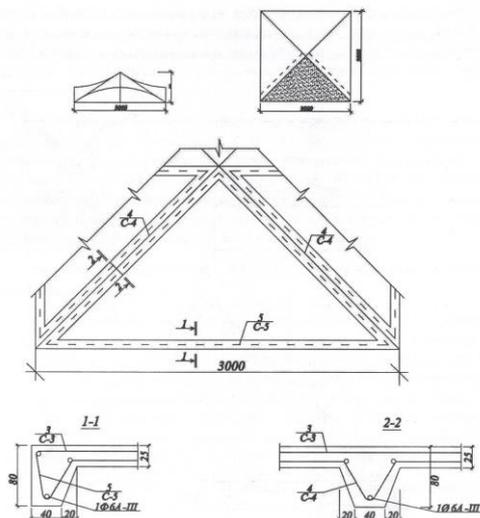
Схема и армирования модели секториальной оболочки отрицательной гауссовой кривизны: 3-сетчатое армирование поля оболочки; 4,5 – тоже приконтурных и угловых зон.
